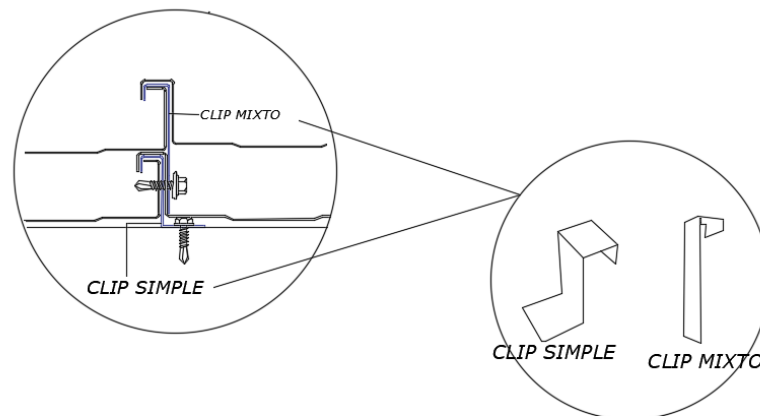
Detalle de traslape entre paneles con pernos y accesorios de fijación.
